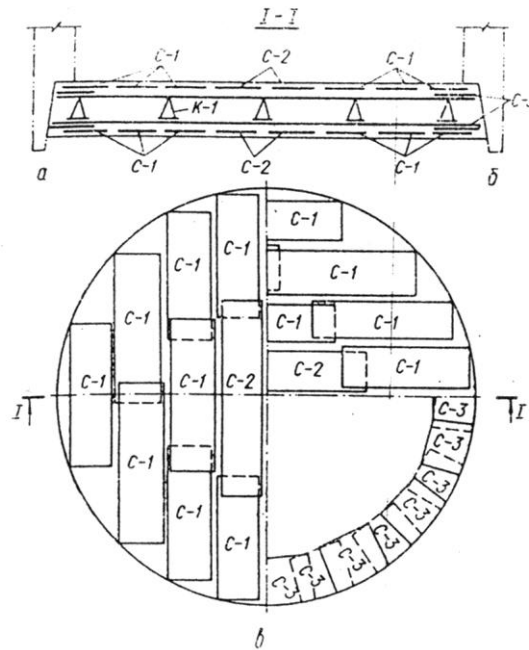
Армування днища: а- поздовжні сітки; б- те ж поперечні; в- те ж кільцеві.
